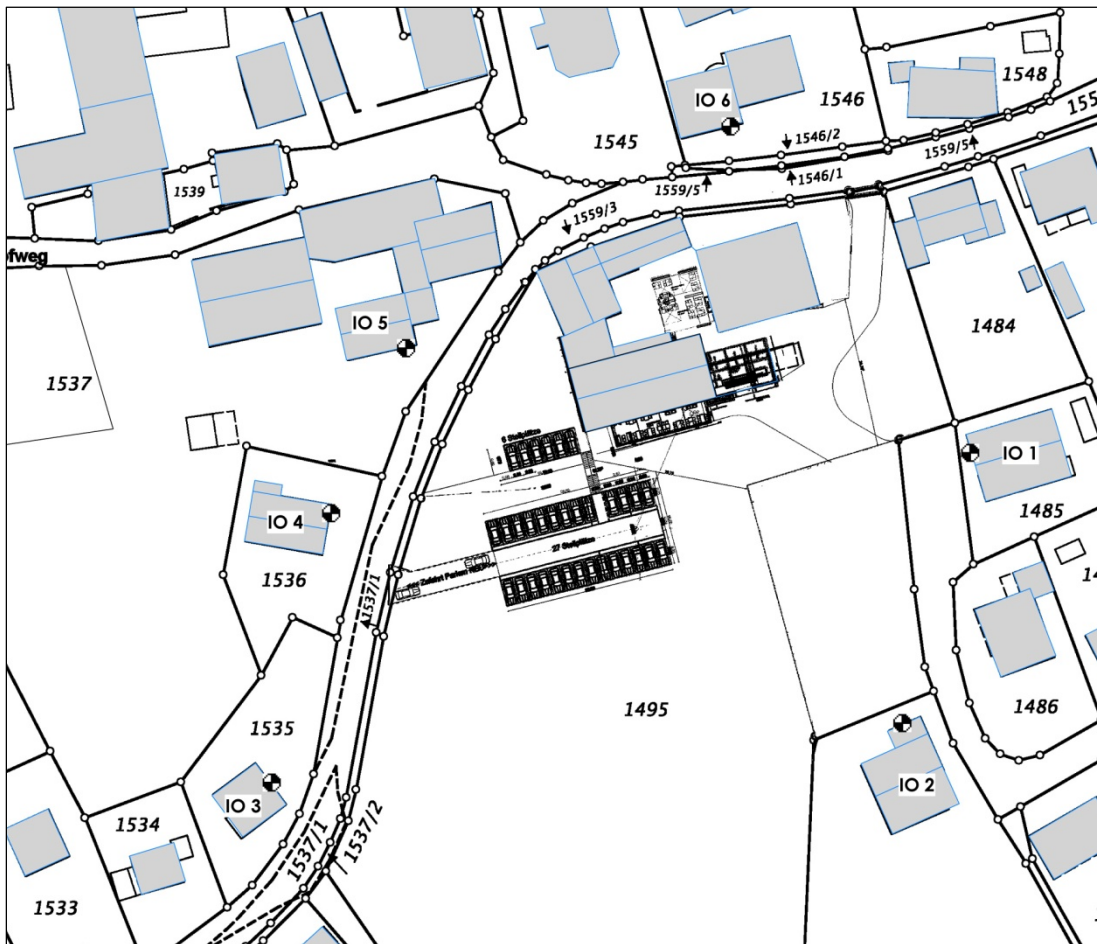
Lageplan mit Darstellung der Immissionsorte (IO)
